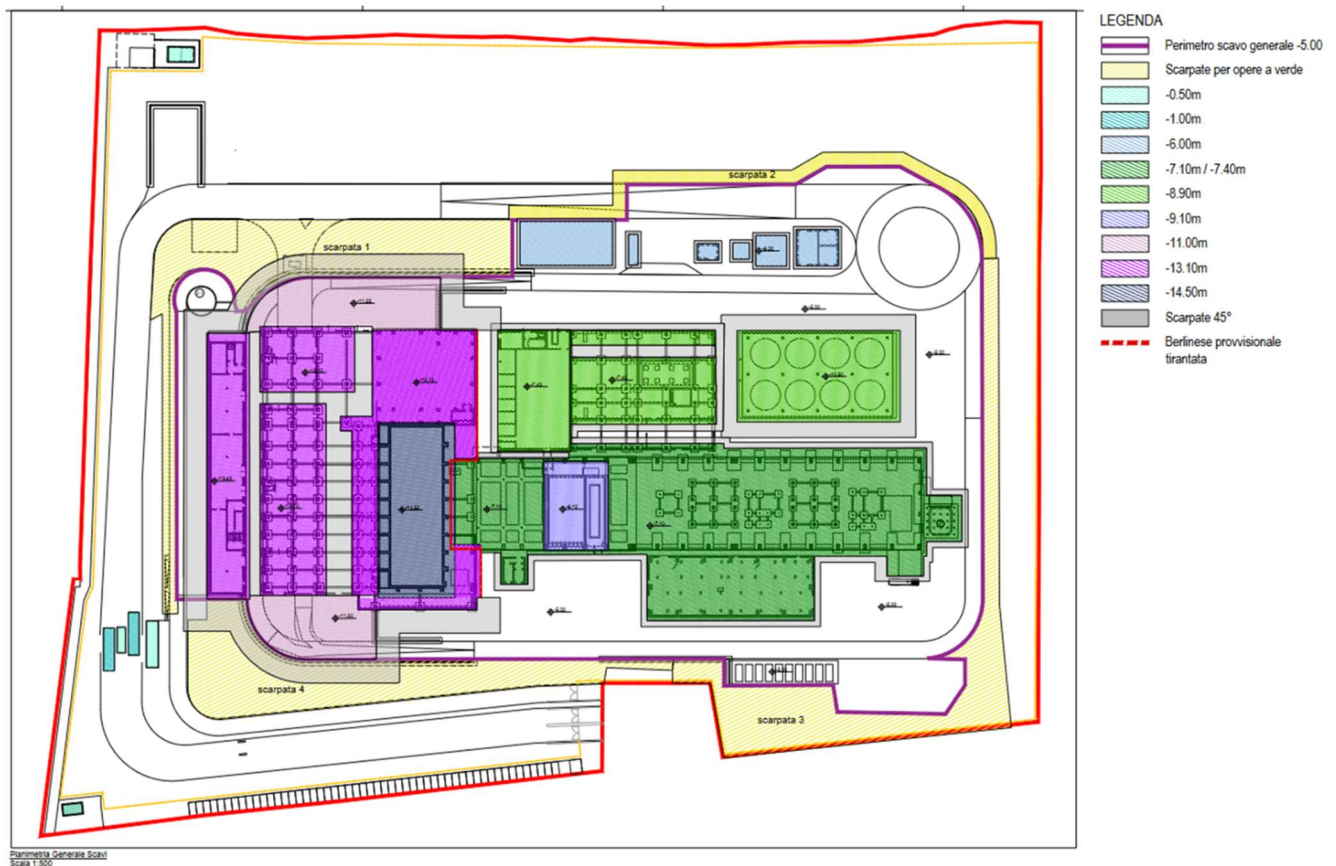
Planimetria scavo area "Ex Zincocelere"
